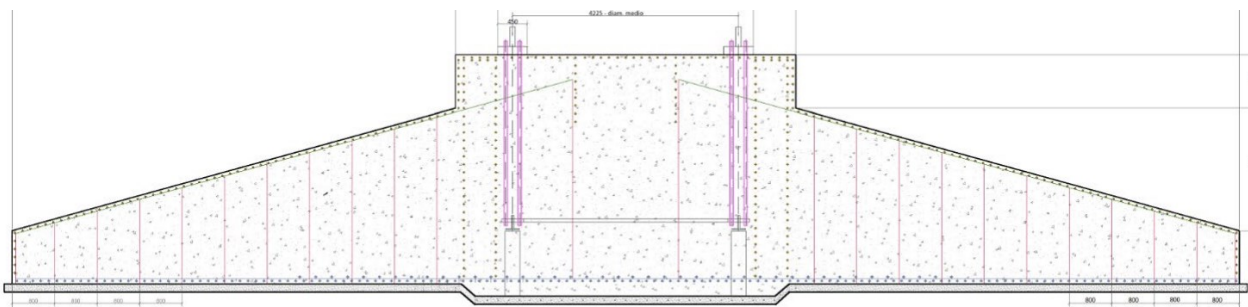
| Schema tipo del plinto di fondazione degli aerogeneratori
